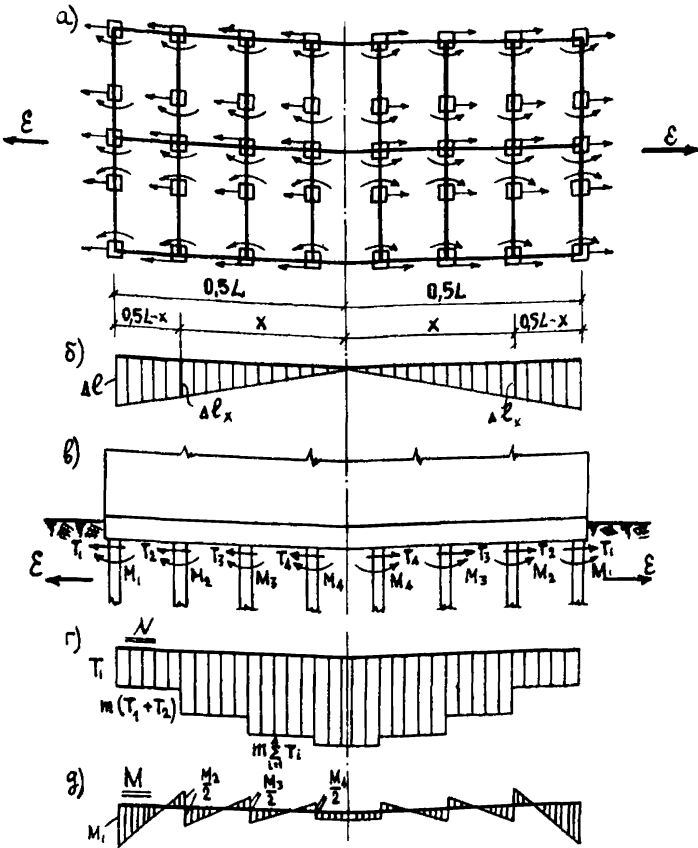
Нагрузки и усилия в ростверке от воздействия горизонтальных деформаций растяжения основания при жесткой заделке голов свай в ростверк: а-план свайного поля; б-эпюра перемещения основания $\Delta \varrho$; в-схема нагрузок действующих на ростверк; г-эпюра усилий в ростверке; д-эпюра изгибающих моментов в ростверке
